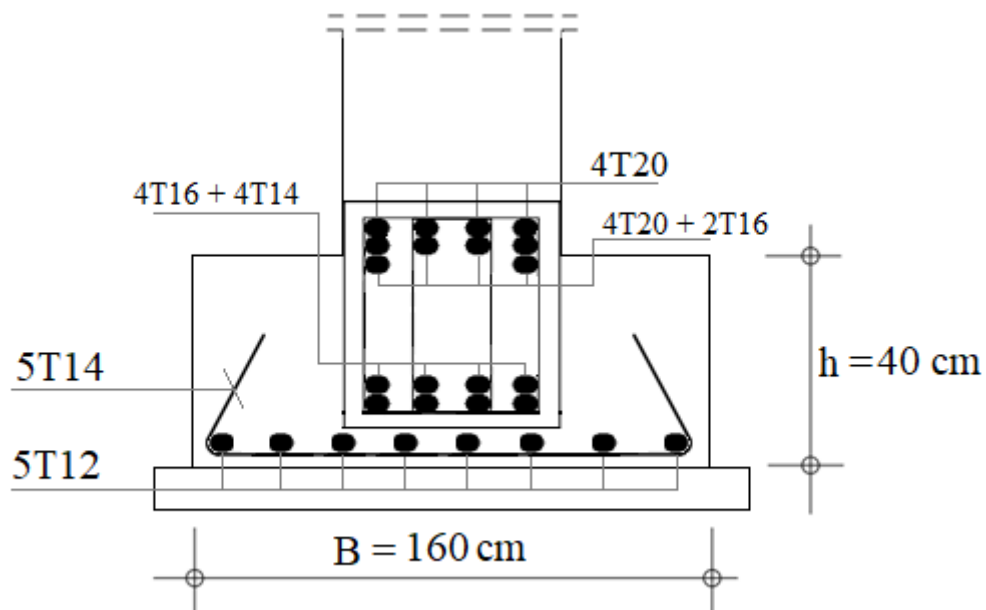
Ferrailage de semelle continue sous murs voiles
